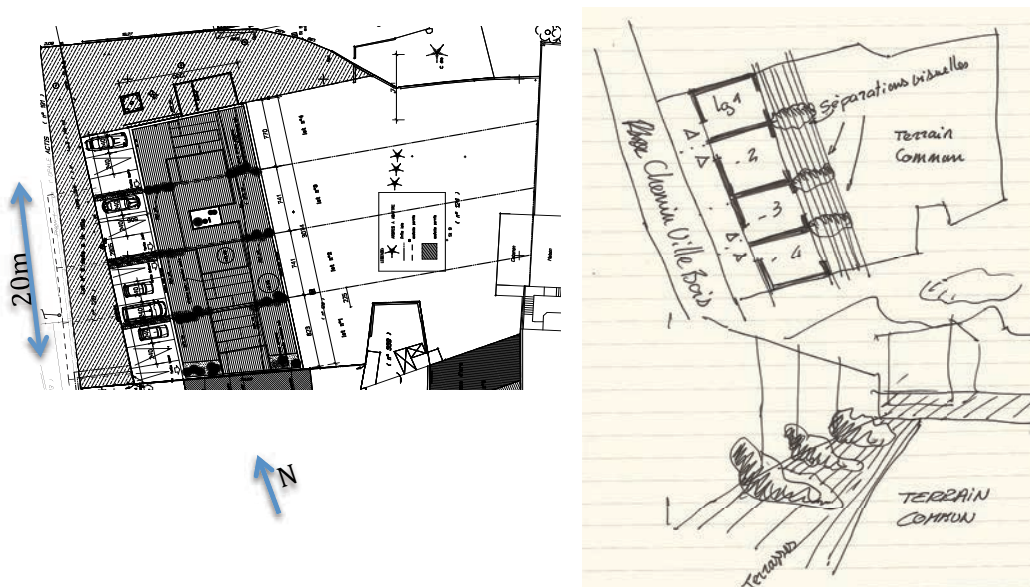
Plan masse et croquis de l'opération « Chemin Villebois ». Plan Autopromoteurs et croquis d'observation E. RUIZ.
